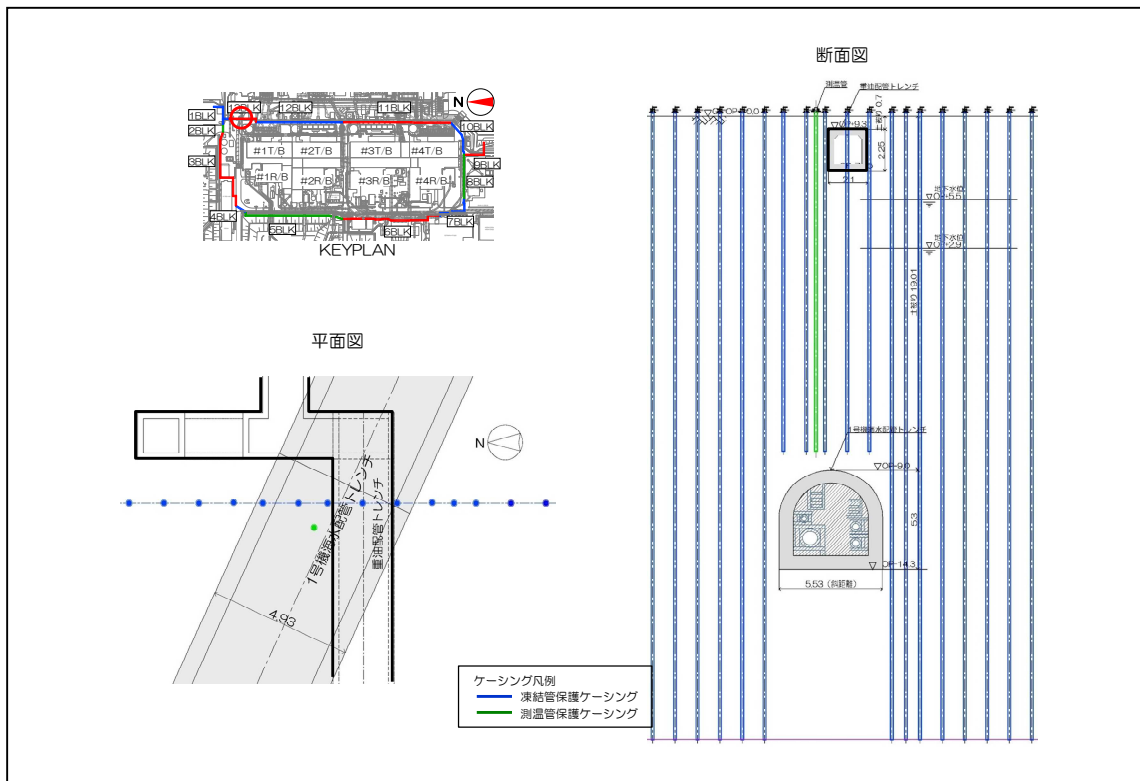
1号機海水配管トレンチ部 施工平面図・断面図
